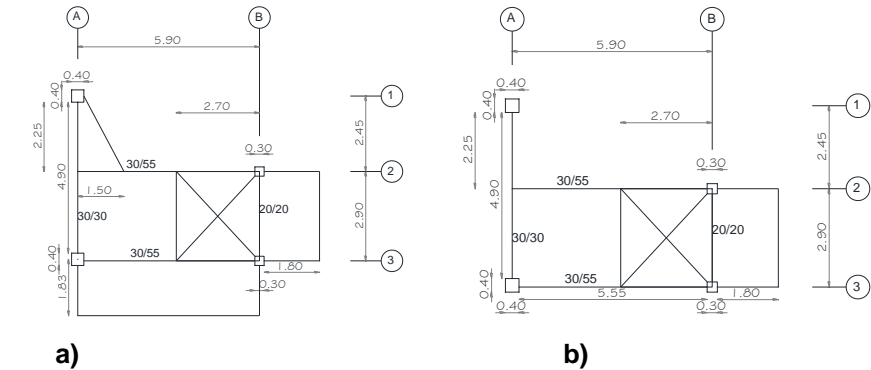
a) Columnas en Planta Baja; b) Columnas en 2da, 3ra y 4ta planta
